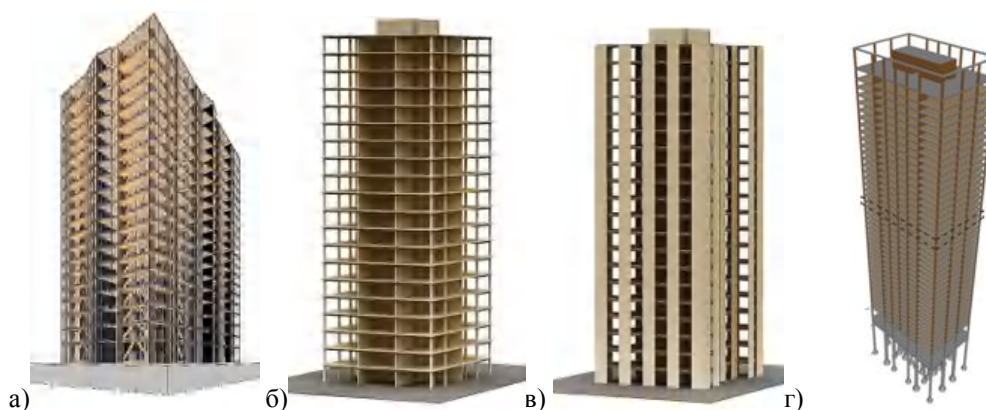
Деревянные зданий гибридной конструкции / Hybrid structure timber buildings : а) Museum Tower Apartment [13]; б), в) FFTT system [5]; г) Timber Tower Research [14]
